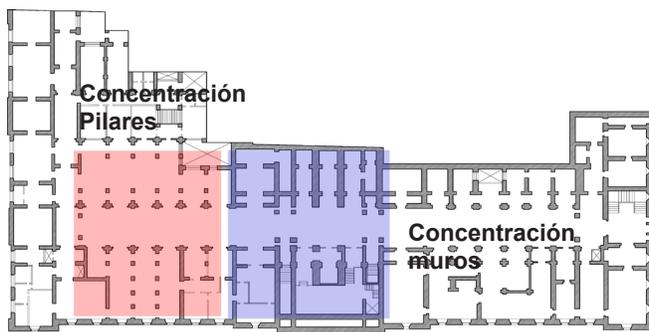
Planta nivel zócalo Palacio de Tribunales. Concentración pilares y muros. Elaboración Propia
